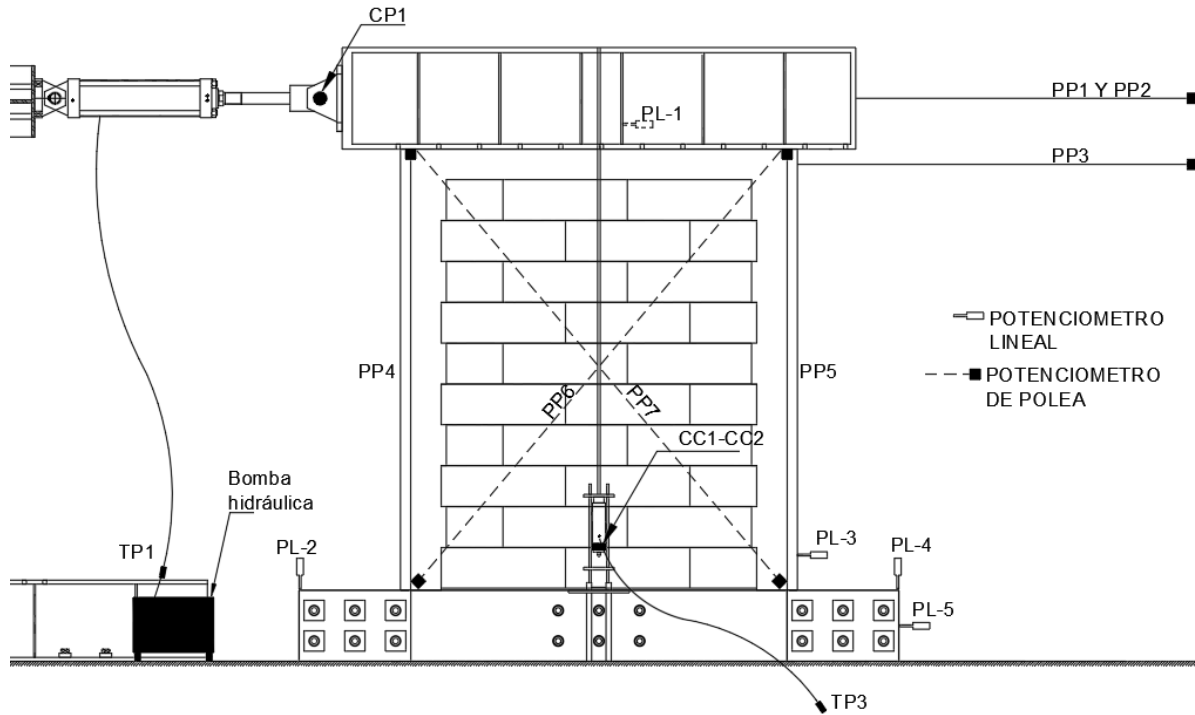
Esquema del sistema de instrumentación muro M-1.23-4.8
